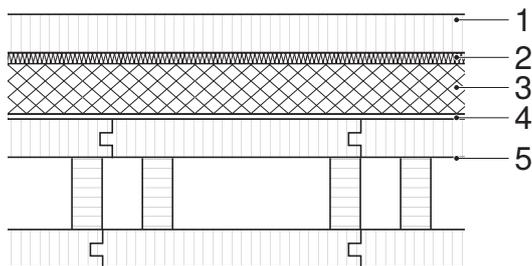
Aufbau einer Holz-Beton-Verbunddecke
